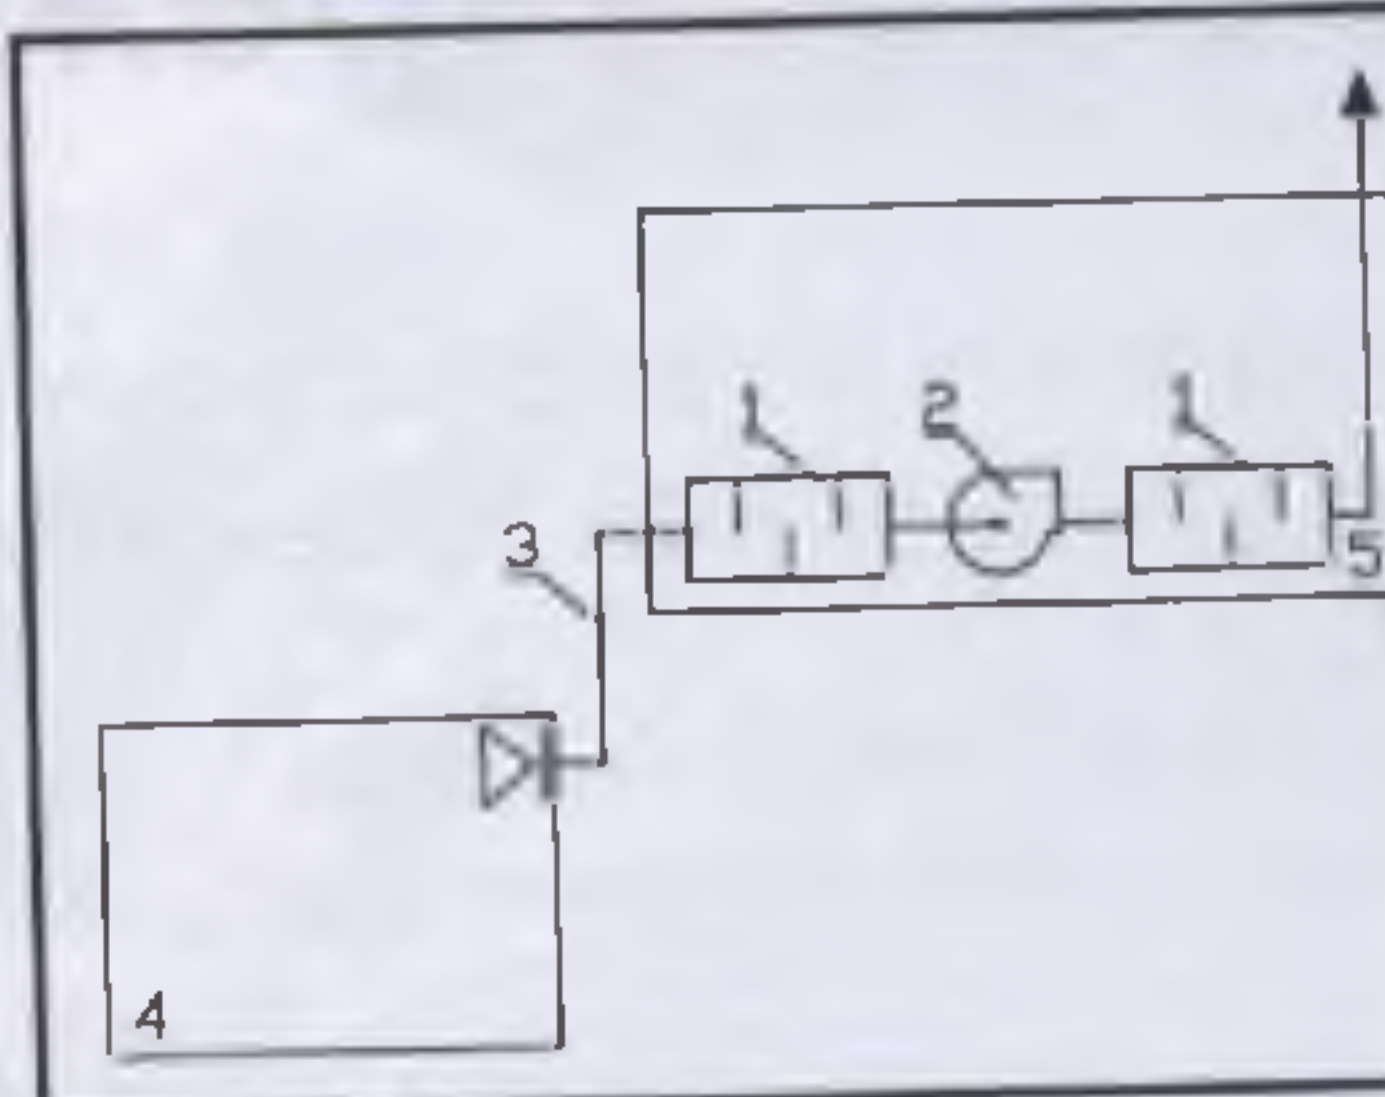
Схема установки шумоглушителя на вытяжном воздуховоде до и после вентилятора
